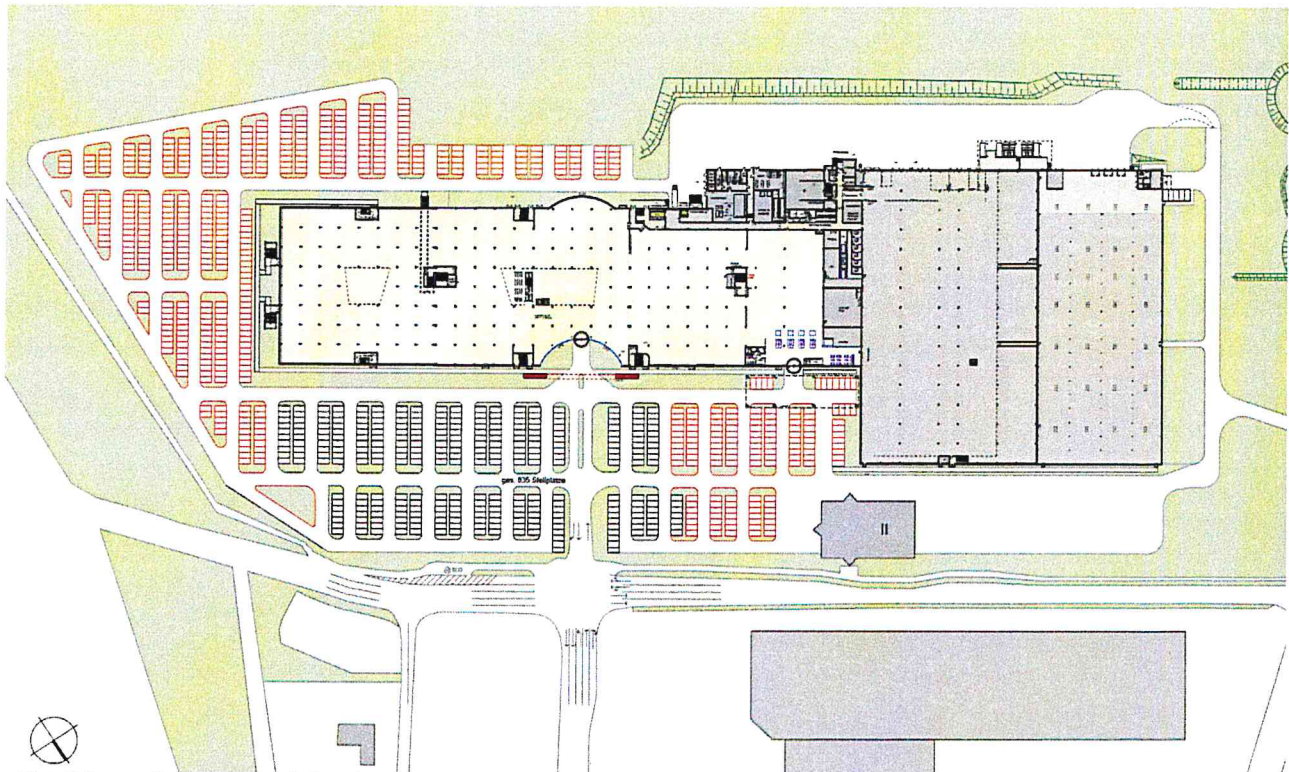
Um- und Ausbauplanung, beier baudeSIGN GmbH, Braunschweig, hier: Erdgeschossgrundriss mit Lageplan ohne Maßstab
